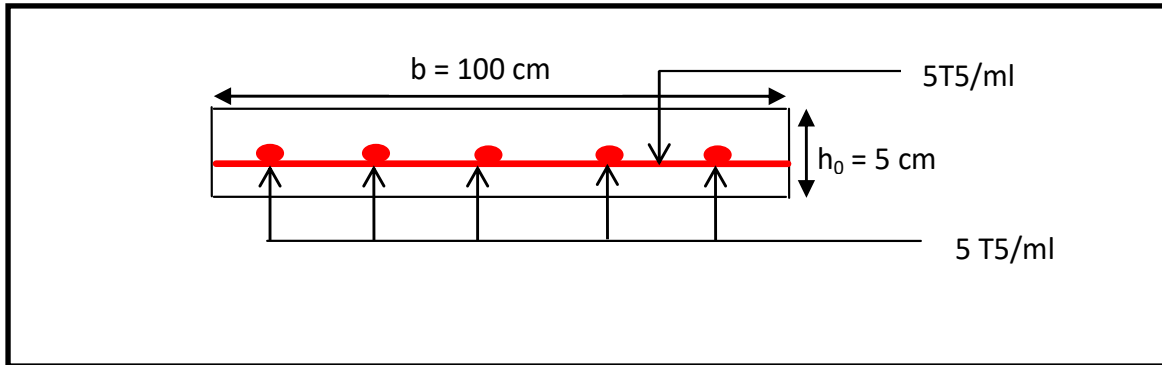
Schéma de ferraillages de la dalle de compression
